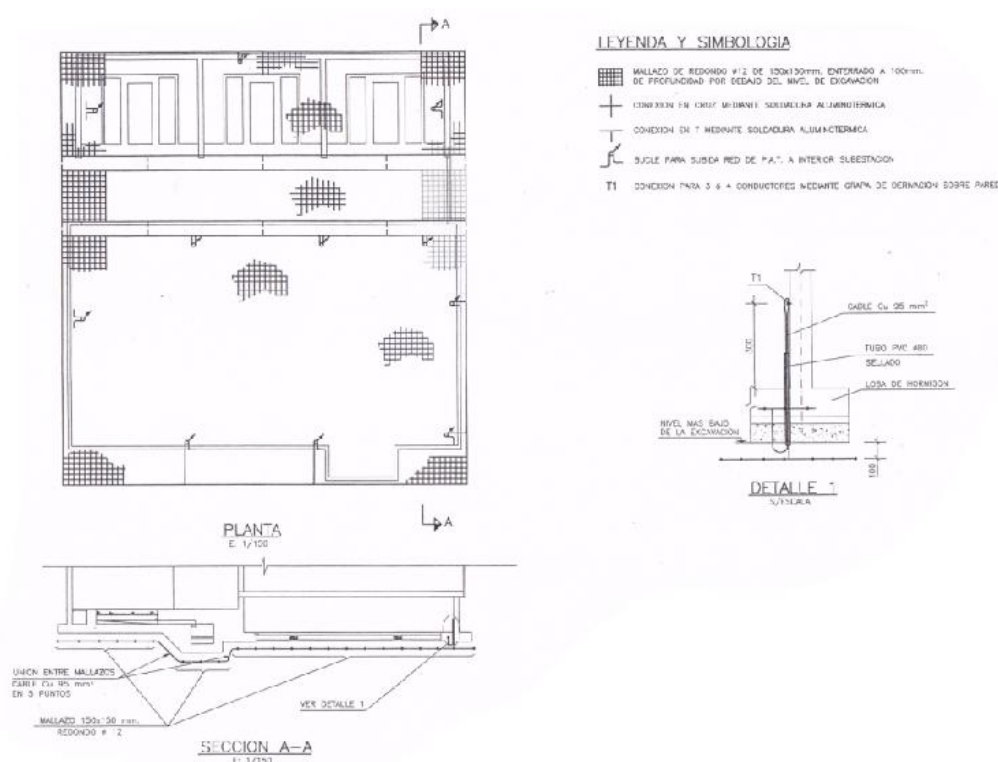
Plano de la red de puesta a tierra de una subestación blindada urbana de 132/20 kV.
